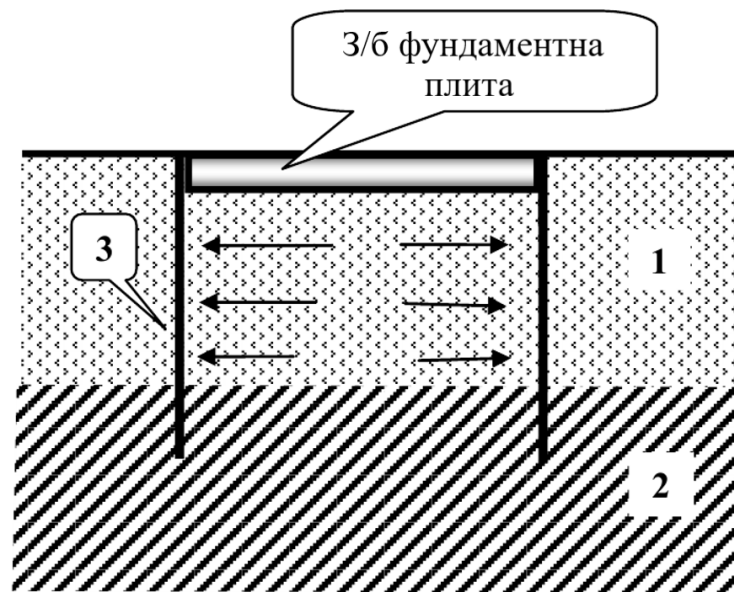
Схема конструктивного посилення з використанням шпунтової обойми: 1 – слабкий ґрунт; 2 – хороший ґрунт; 3 – шпунт по периметру фундаментної плити
